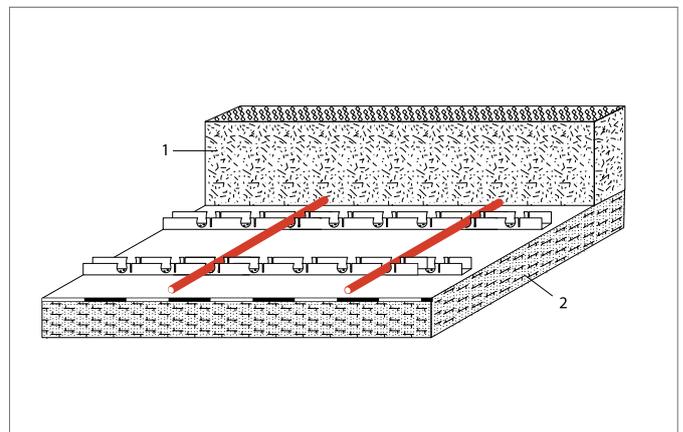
Mit Stahlfasern bewehrte Bodenplatte und Walzbeton; Sonderkonstruktion Heizungsrohre auf den Klemmschienen montiert
